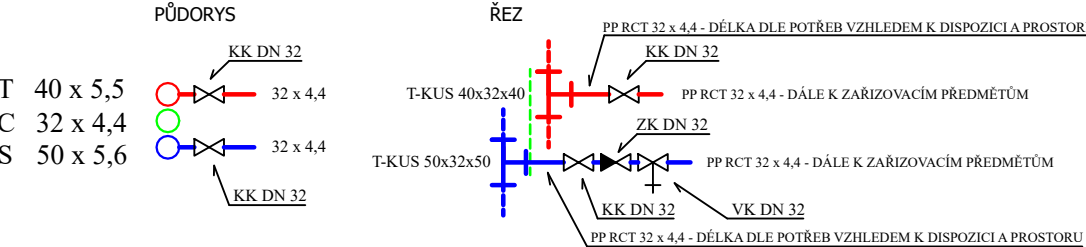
NAPOJENÍ PŘIPOJOVACÍHO POTRUBÍ
